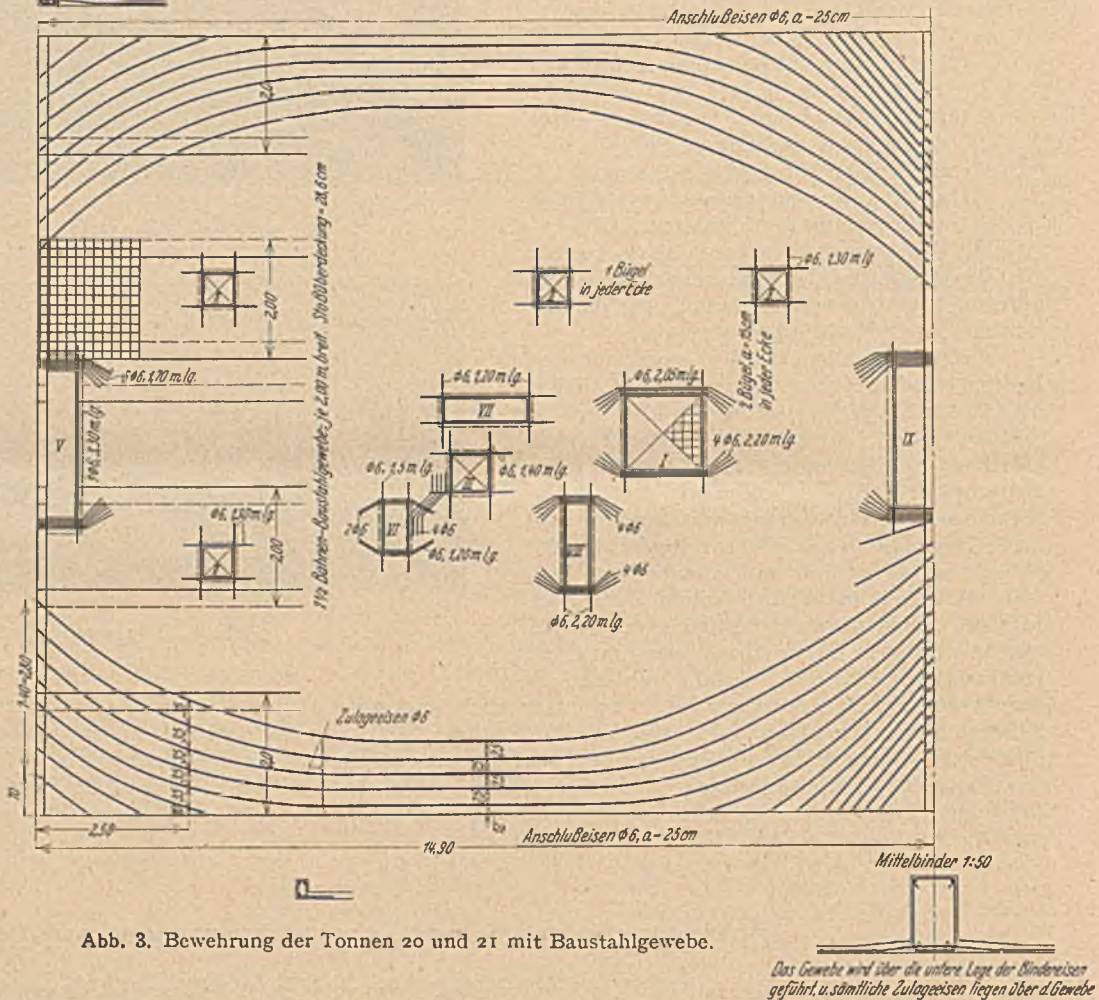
Bewehrung der Tonnen 20 und 21 mit Baustahlgewebe.
